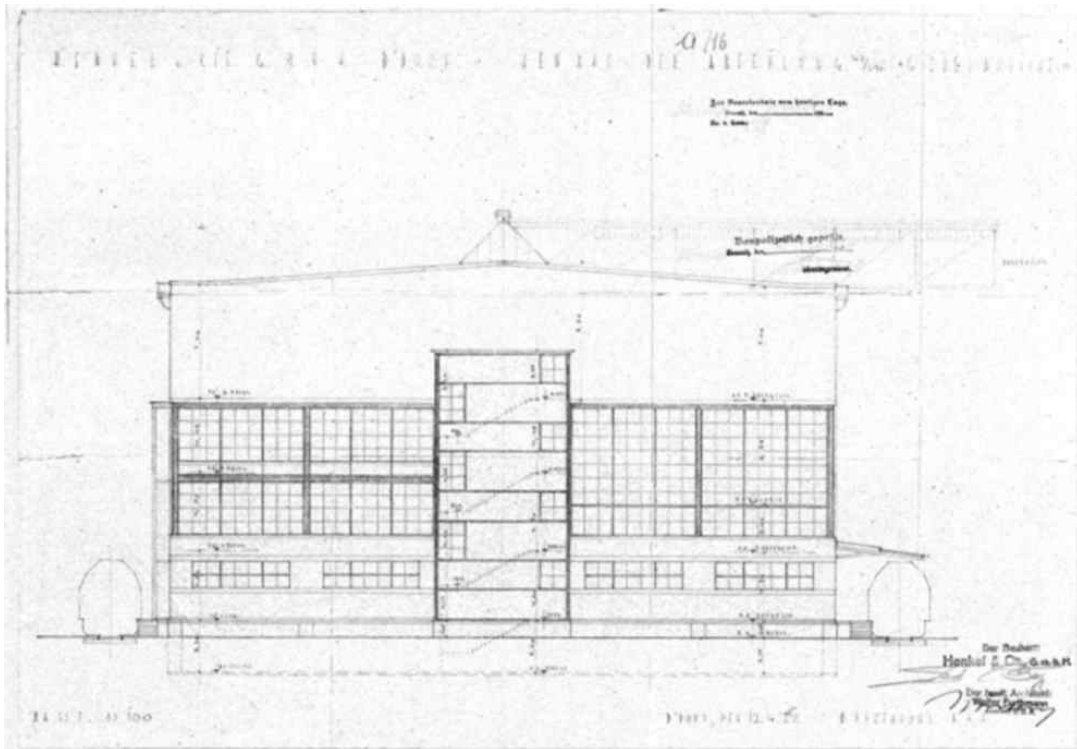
Neubau Packereigebäude Geb. C 05, 1929 - Architekt: Walter Furthmann
